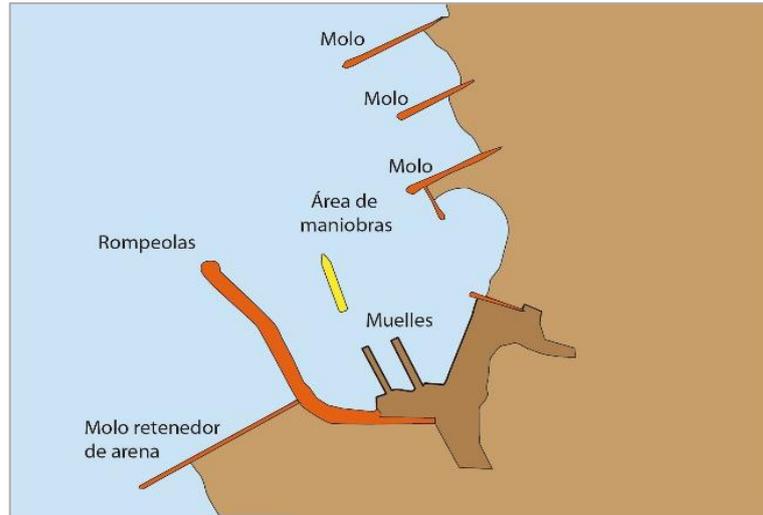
Puerto Salaverry – Muelles espigón
